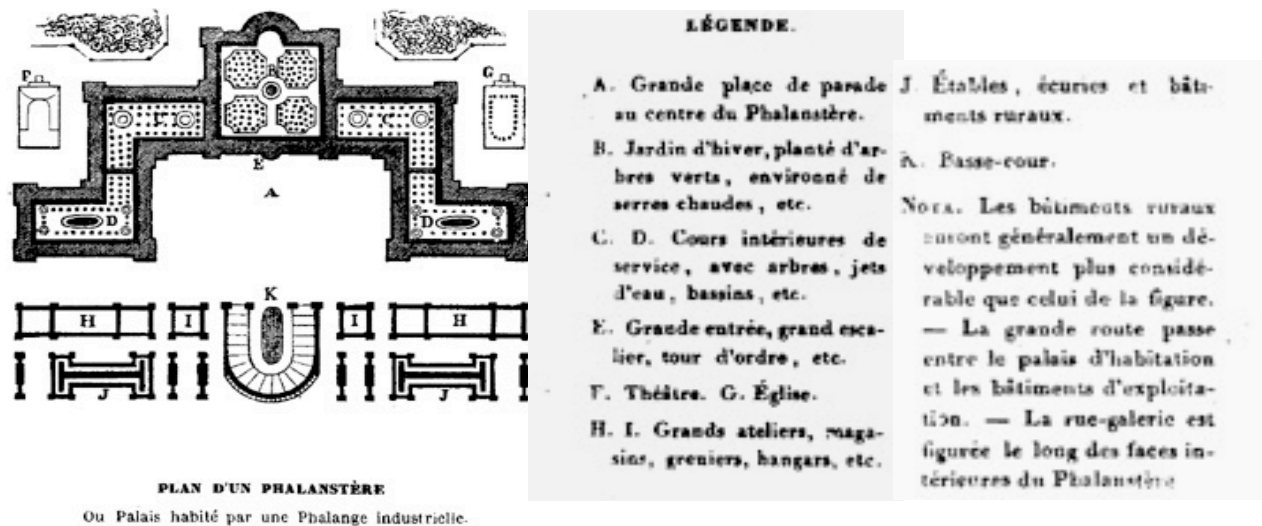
Plan d'un Phalanstère d'après Fourier C., 1829.
